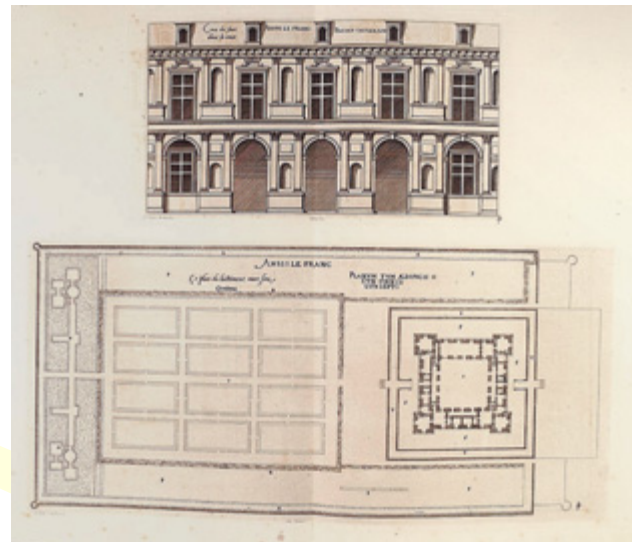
Ancy-Le-Franc, Schloss. Fassadenaufriß und Grundriß des Schlossbaus, 1540 bis 1542 (nach ANDROUET DU CERCEAU 1576).
